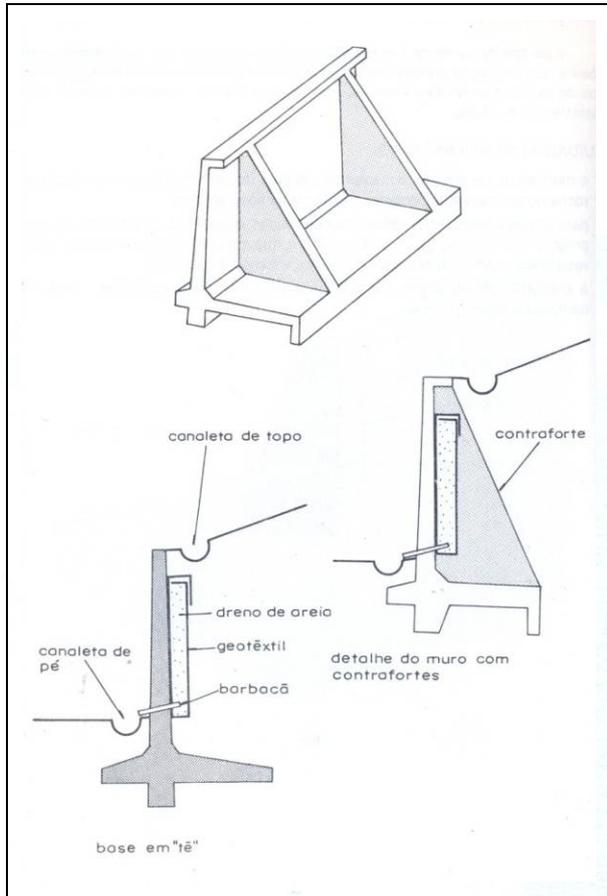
Contenção com muro de concreto armado (flexão) (IPT, 1991).
